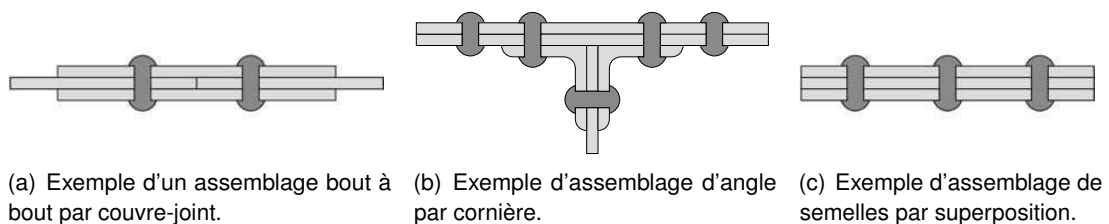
Dispositions constructives utilisées dans les assemblages rivetés.
